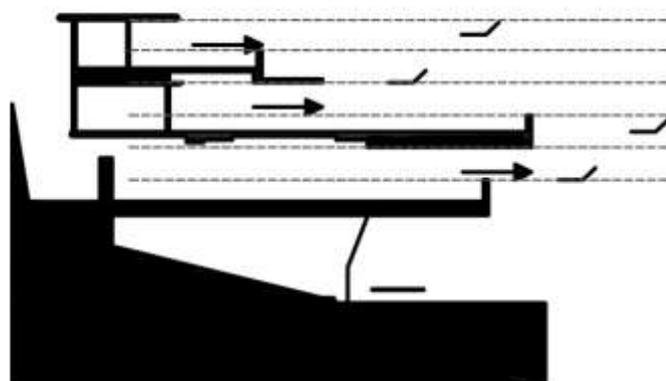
Diagramme de l'auteur. Fond de coupe : Columbia FLLW 3602 p. 8 (detail)
